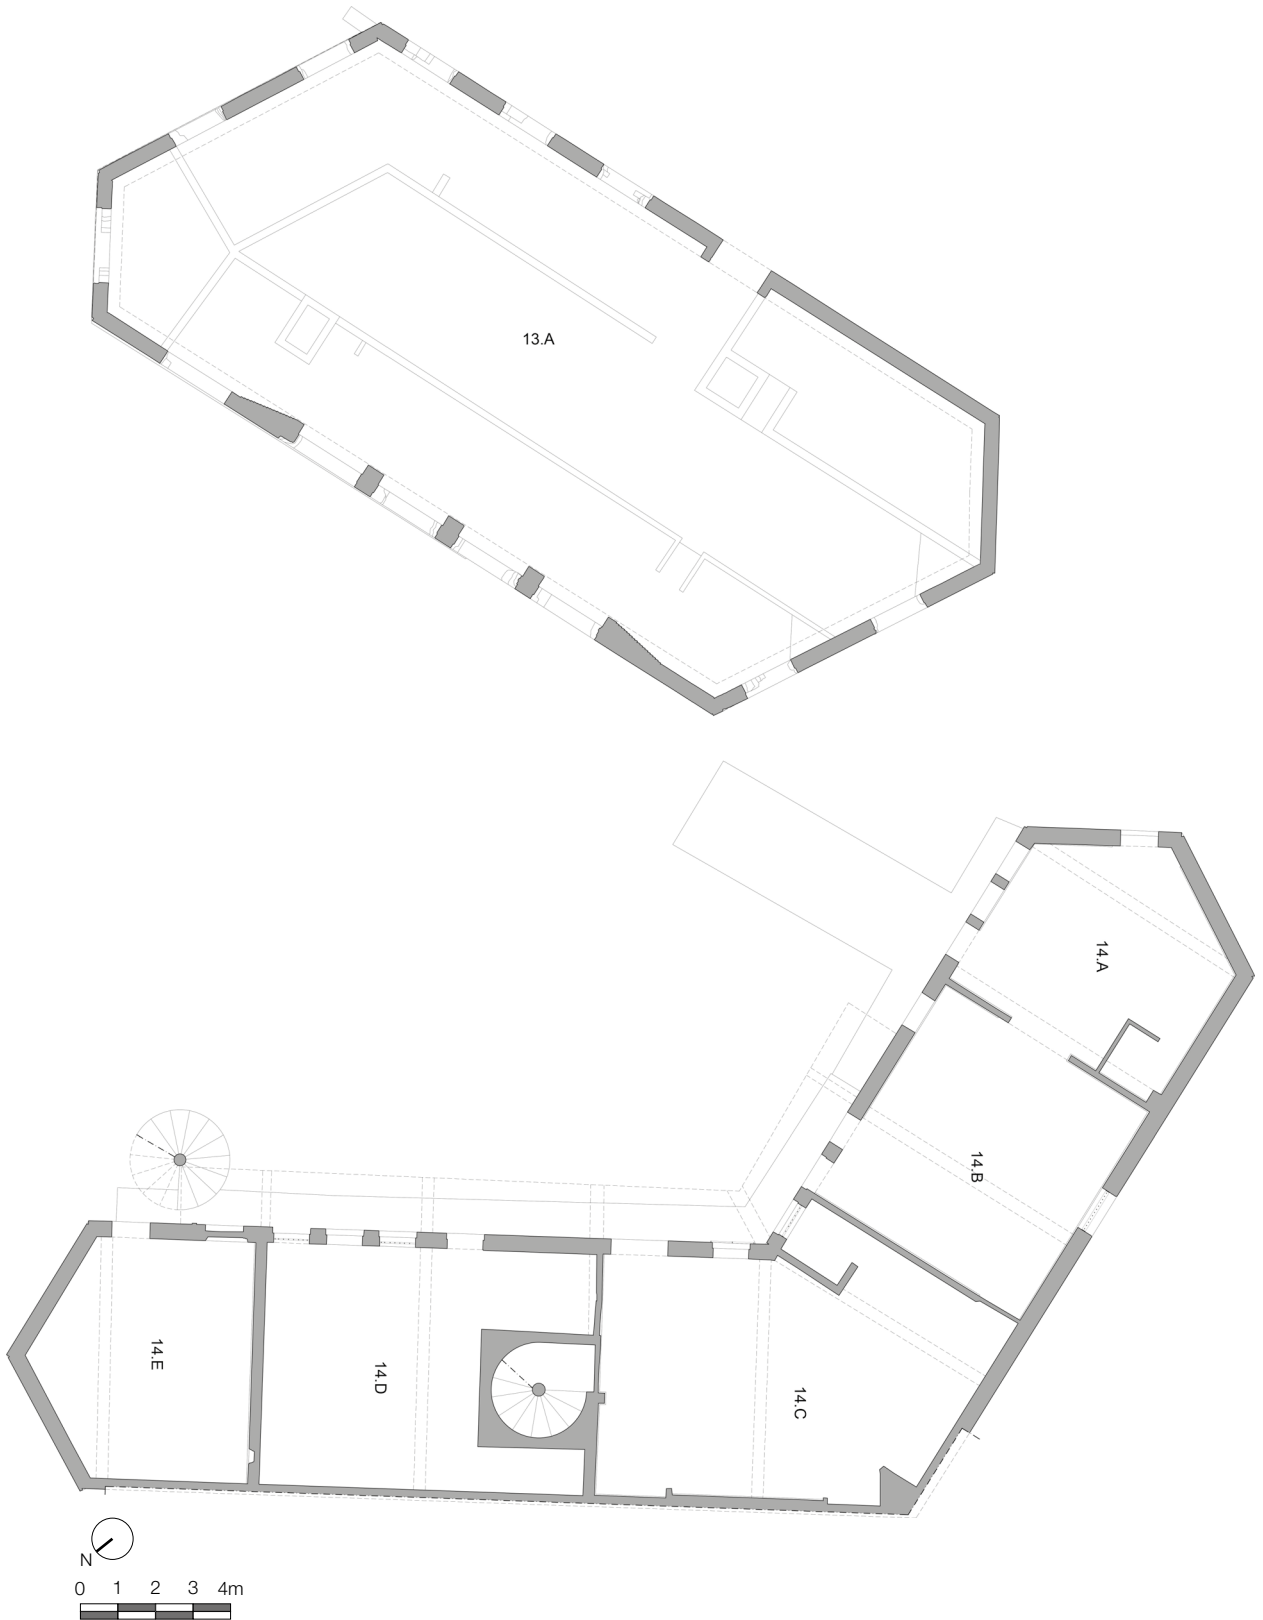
| Planta de los bloques 13 y 14 (escala original de representación 1:50). |
